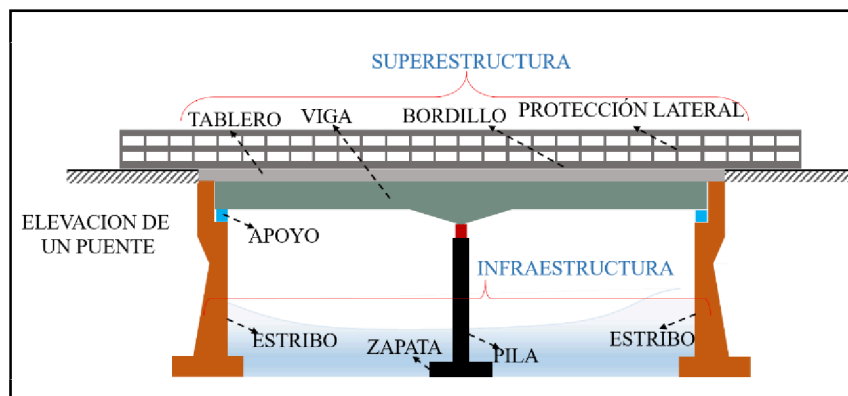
Partes de un puente vehicular (Superestructura e Infraestructura)
